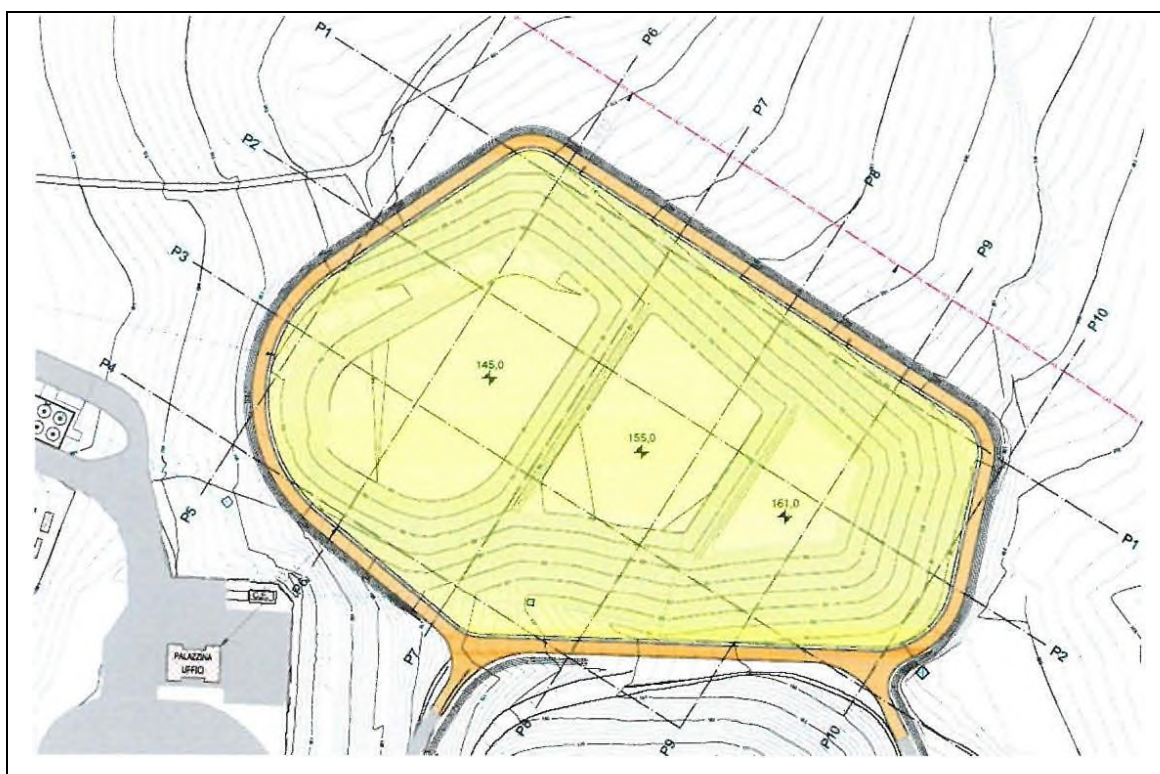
Planimetria della discarica con individuazione dei tre bacini.
